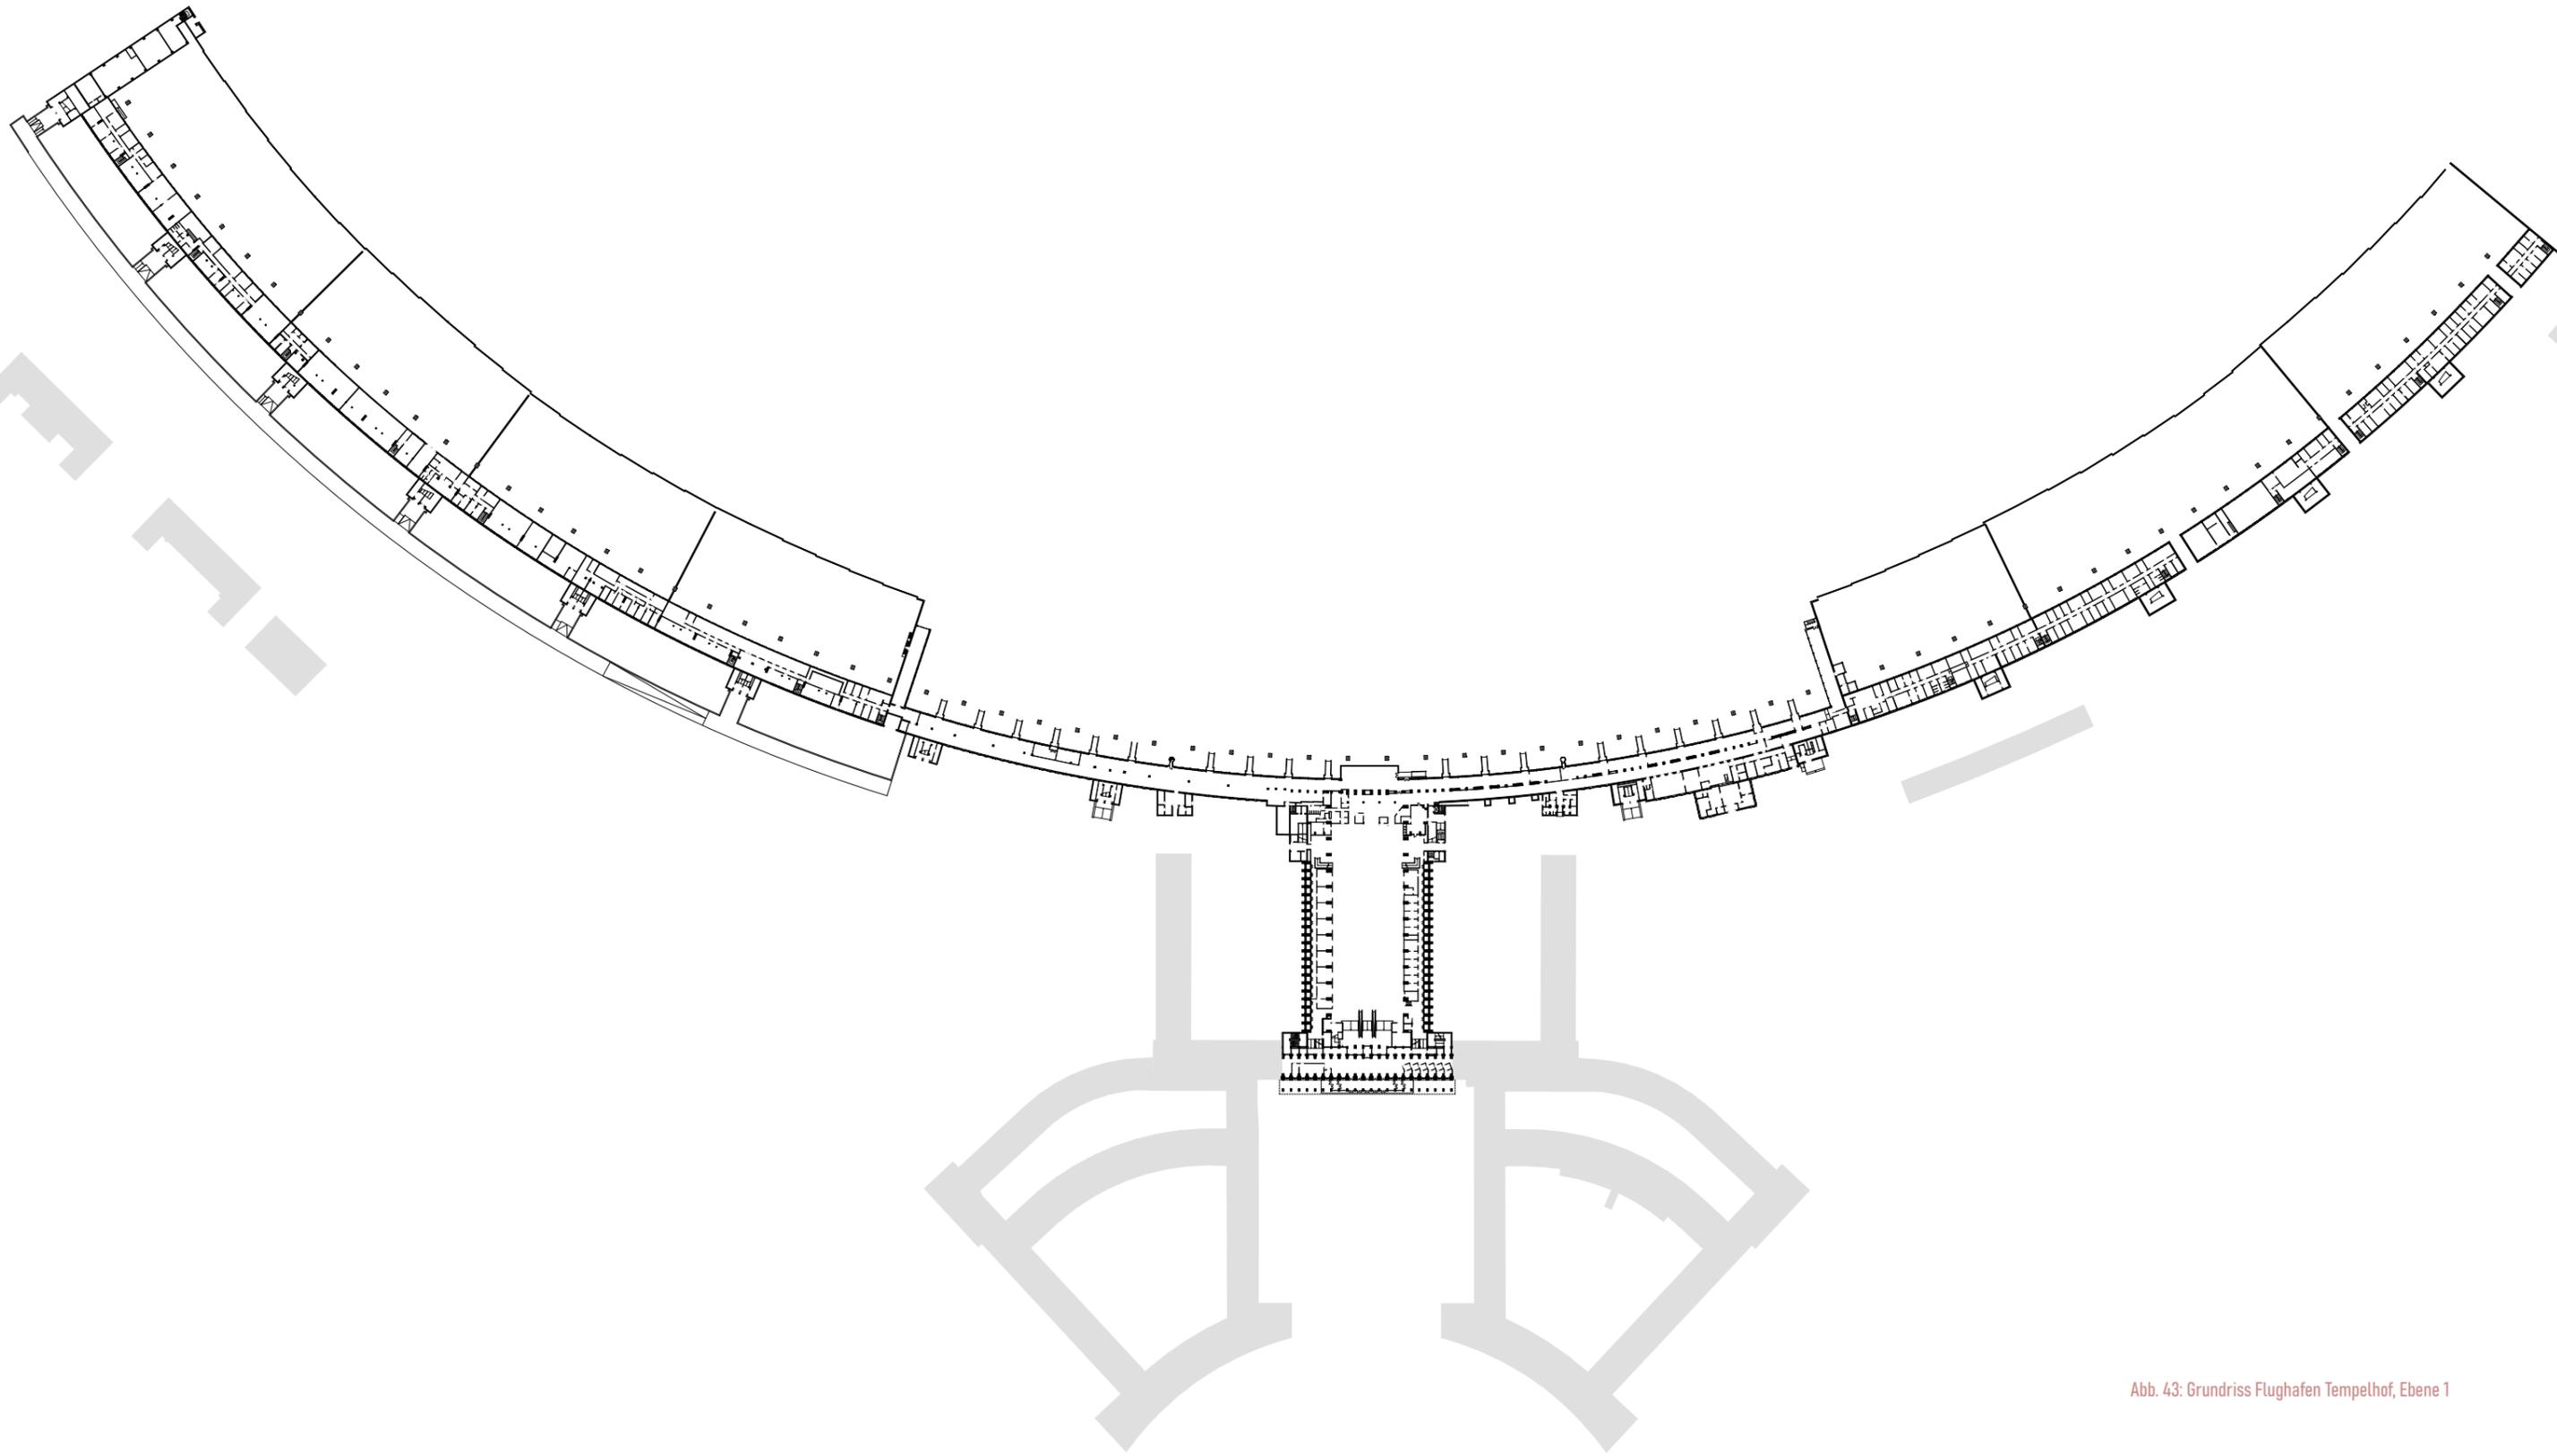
Grundriss Flughafen Tempelhof, Ebene 1
